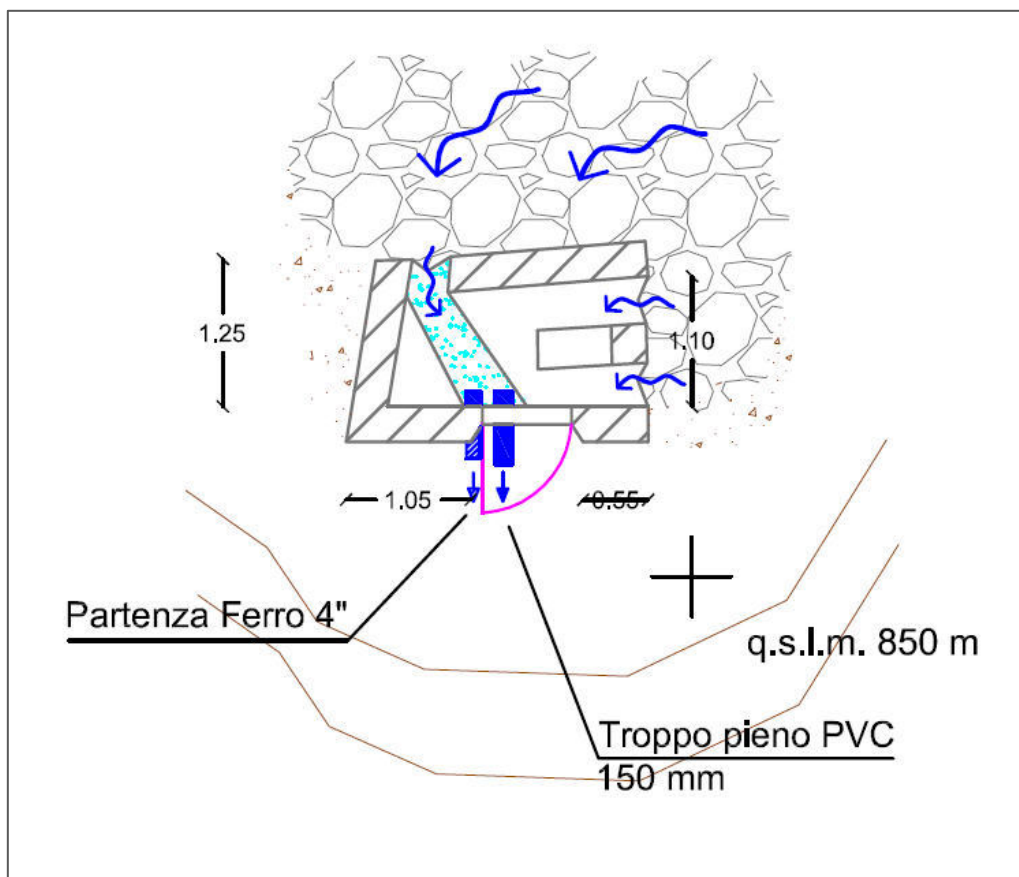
Pianta e Prospetto frontale Sorgente 2 Le Mesore
